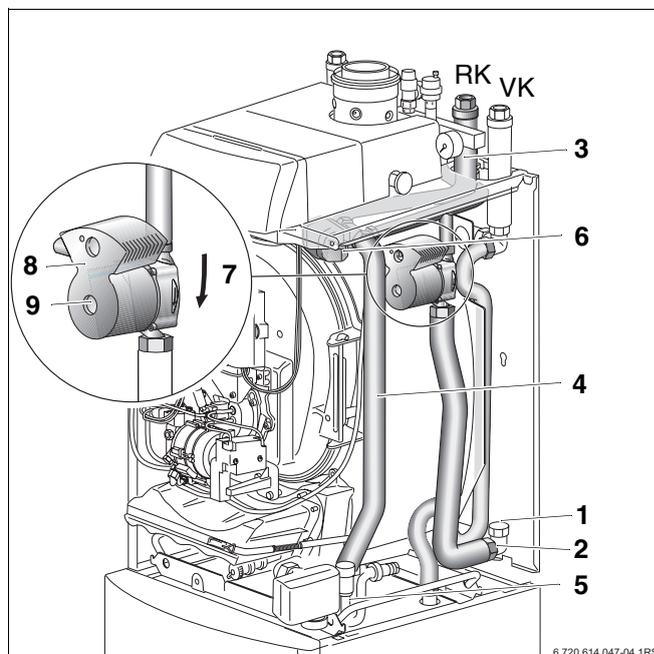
Rücklaufrohrgruppe mit 3-Wege-Ventil montieren
